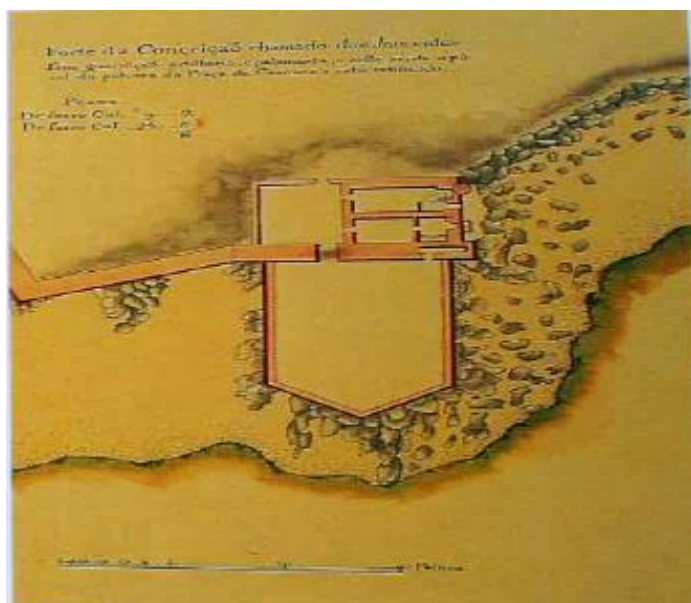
Planta do Forte de Nossa Senhora da Conceição
